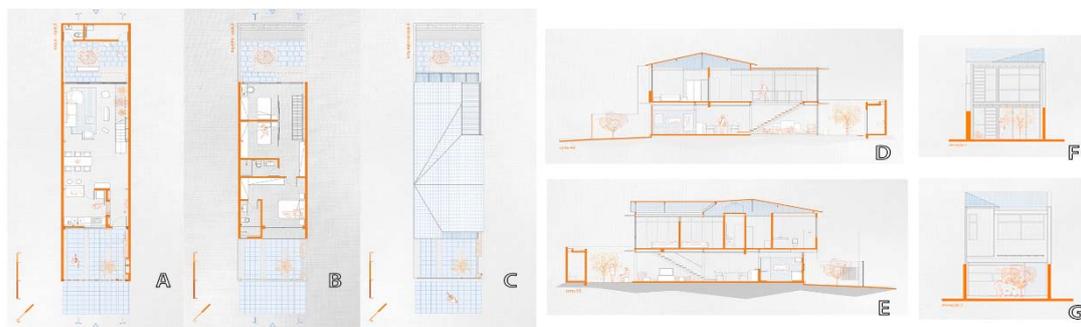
Plantas e cortes da Casa Maria Carolina.
